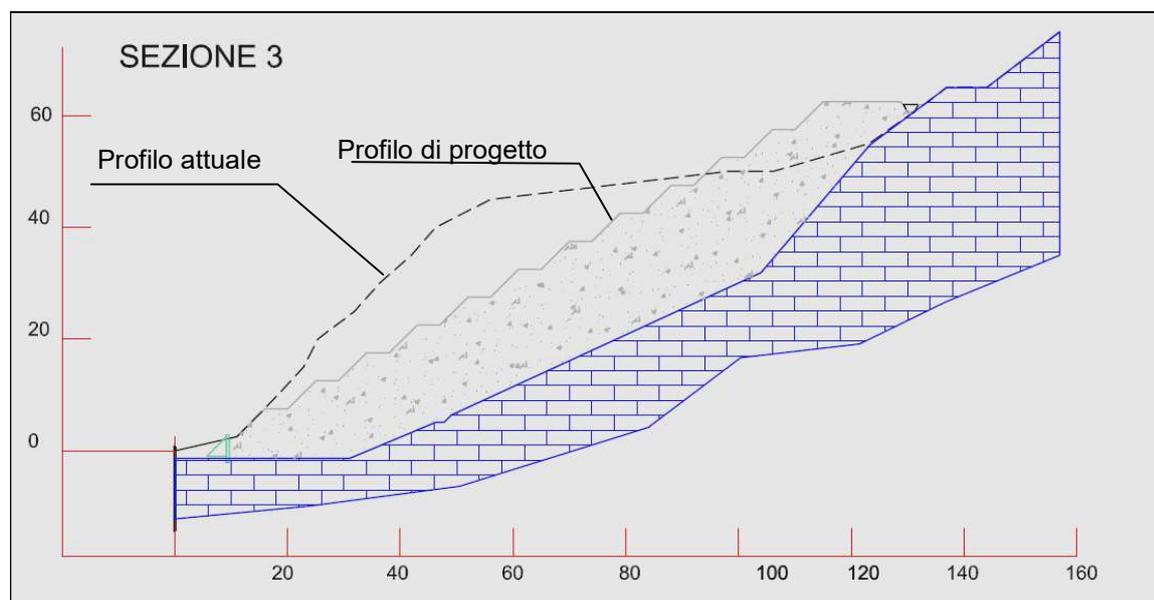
Sezione trasversale alla discarica con la rappresentazione dello stato attuale e dello stato di progetto
